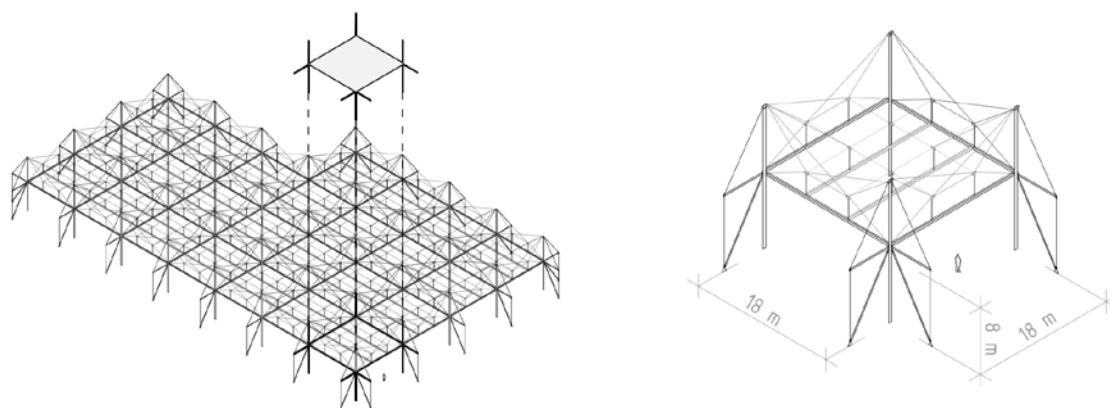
Axonometría de la fábrica, y módulo estructural. Fuente: Elaboración propia.
